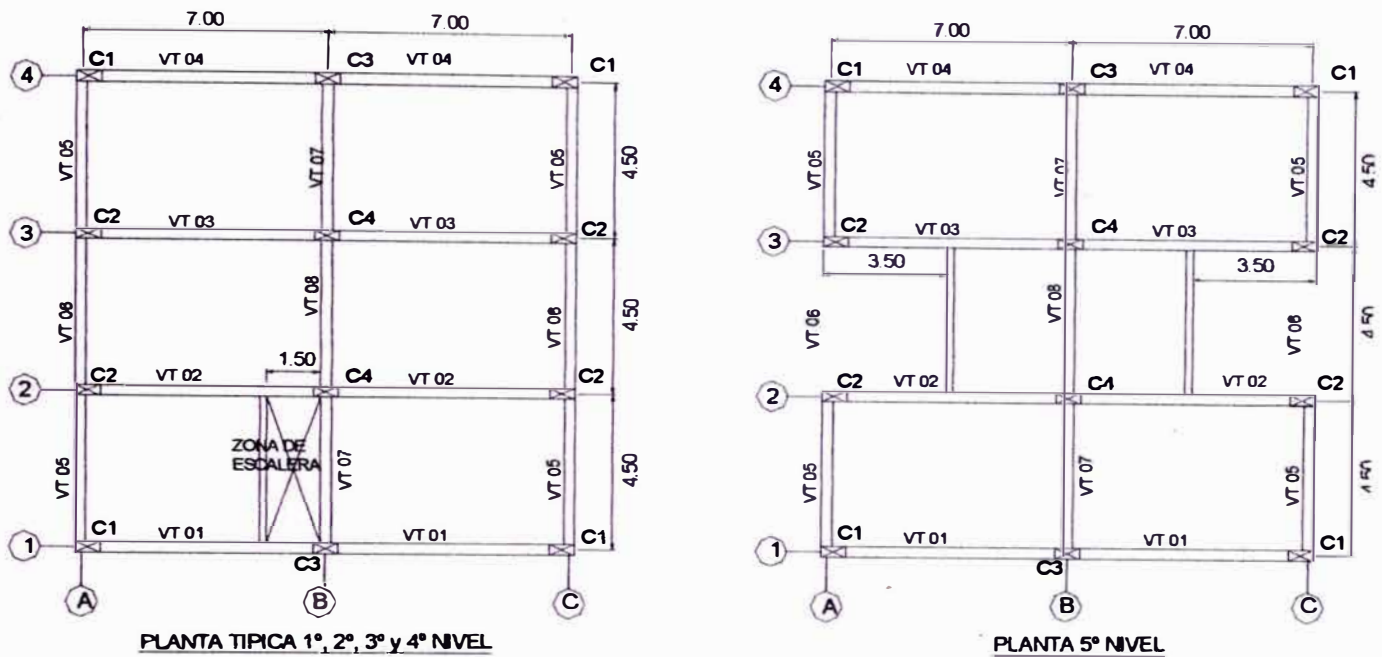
Planta típica y de azotea de la estructura por analizar
